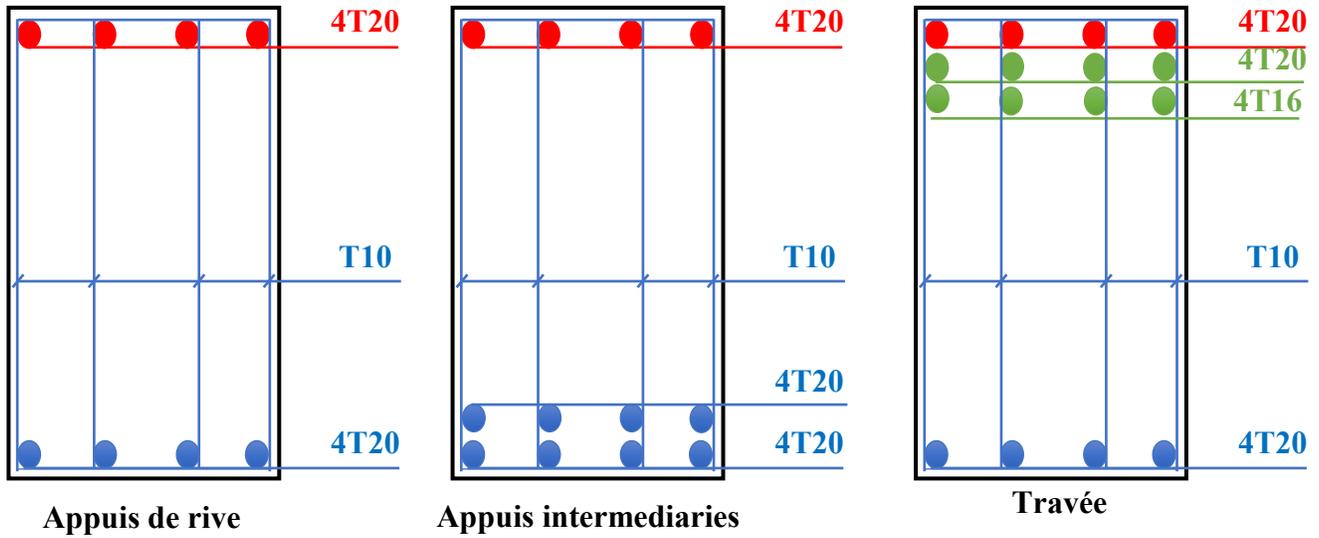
Ferrailage de la poutre de libage (sens longitudinal)
